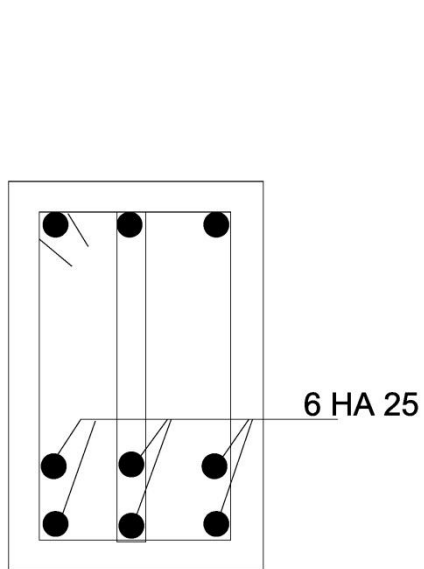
Coupe transversale sur appui d'une nervure longitudinale
